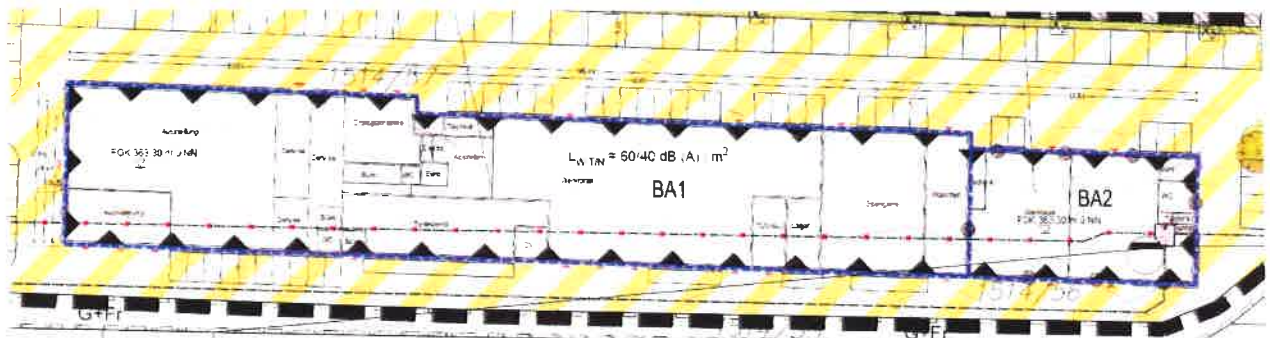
Bauabschnitt 1, westlicher Gebäudeteil, Bauabschnitt 2 östlicher Gebäudeteil
